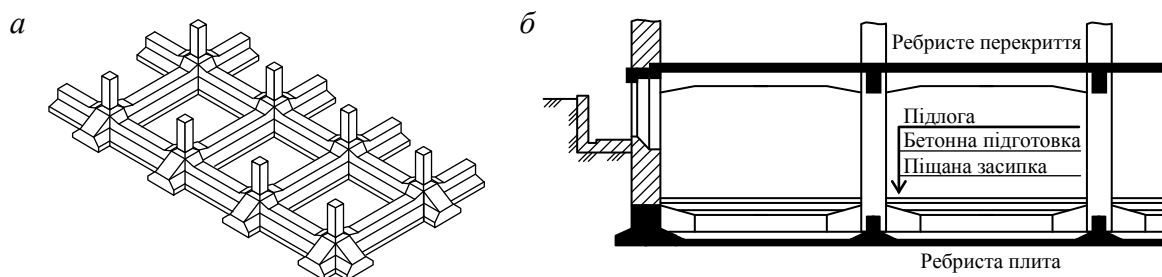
Перехресні фундаменти (а) та фундаменти у вигляді ребристої плити (б)
